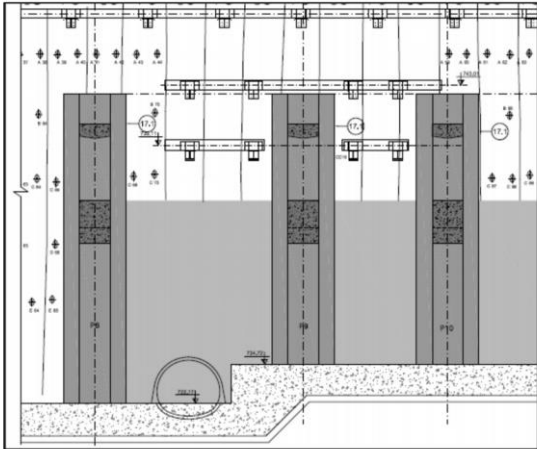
Planta demonstrando a parede diafragma (fundo branco) e o revestimento secundário à frente dela, dividido em pilares (cinza escuro) e paredes (cinza claro)
